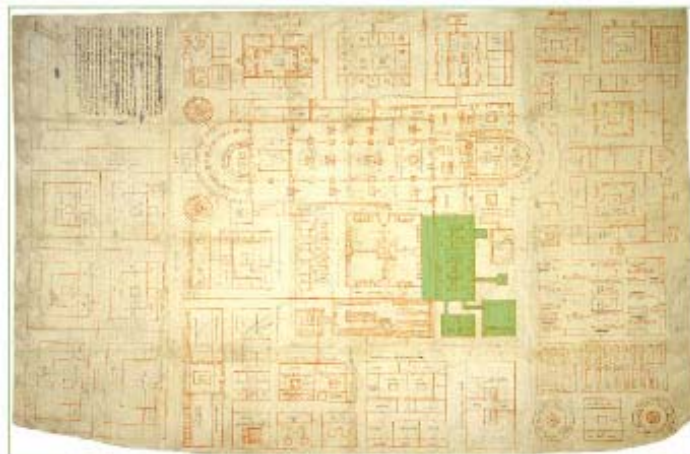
Klosterplan, Planausschnitt östl. Kreuzgang, Calefactorium/Dormitorium, Bad und Latrine
